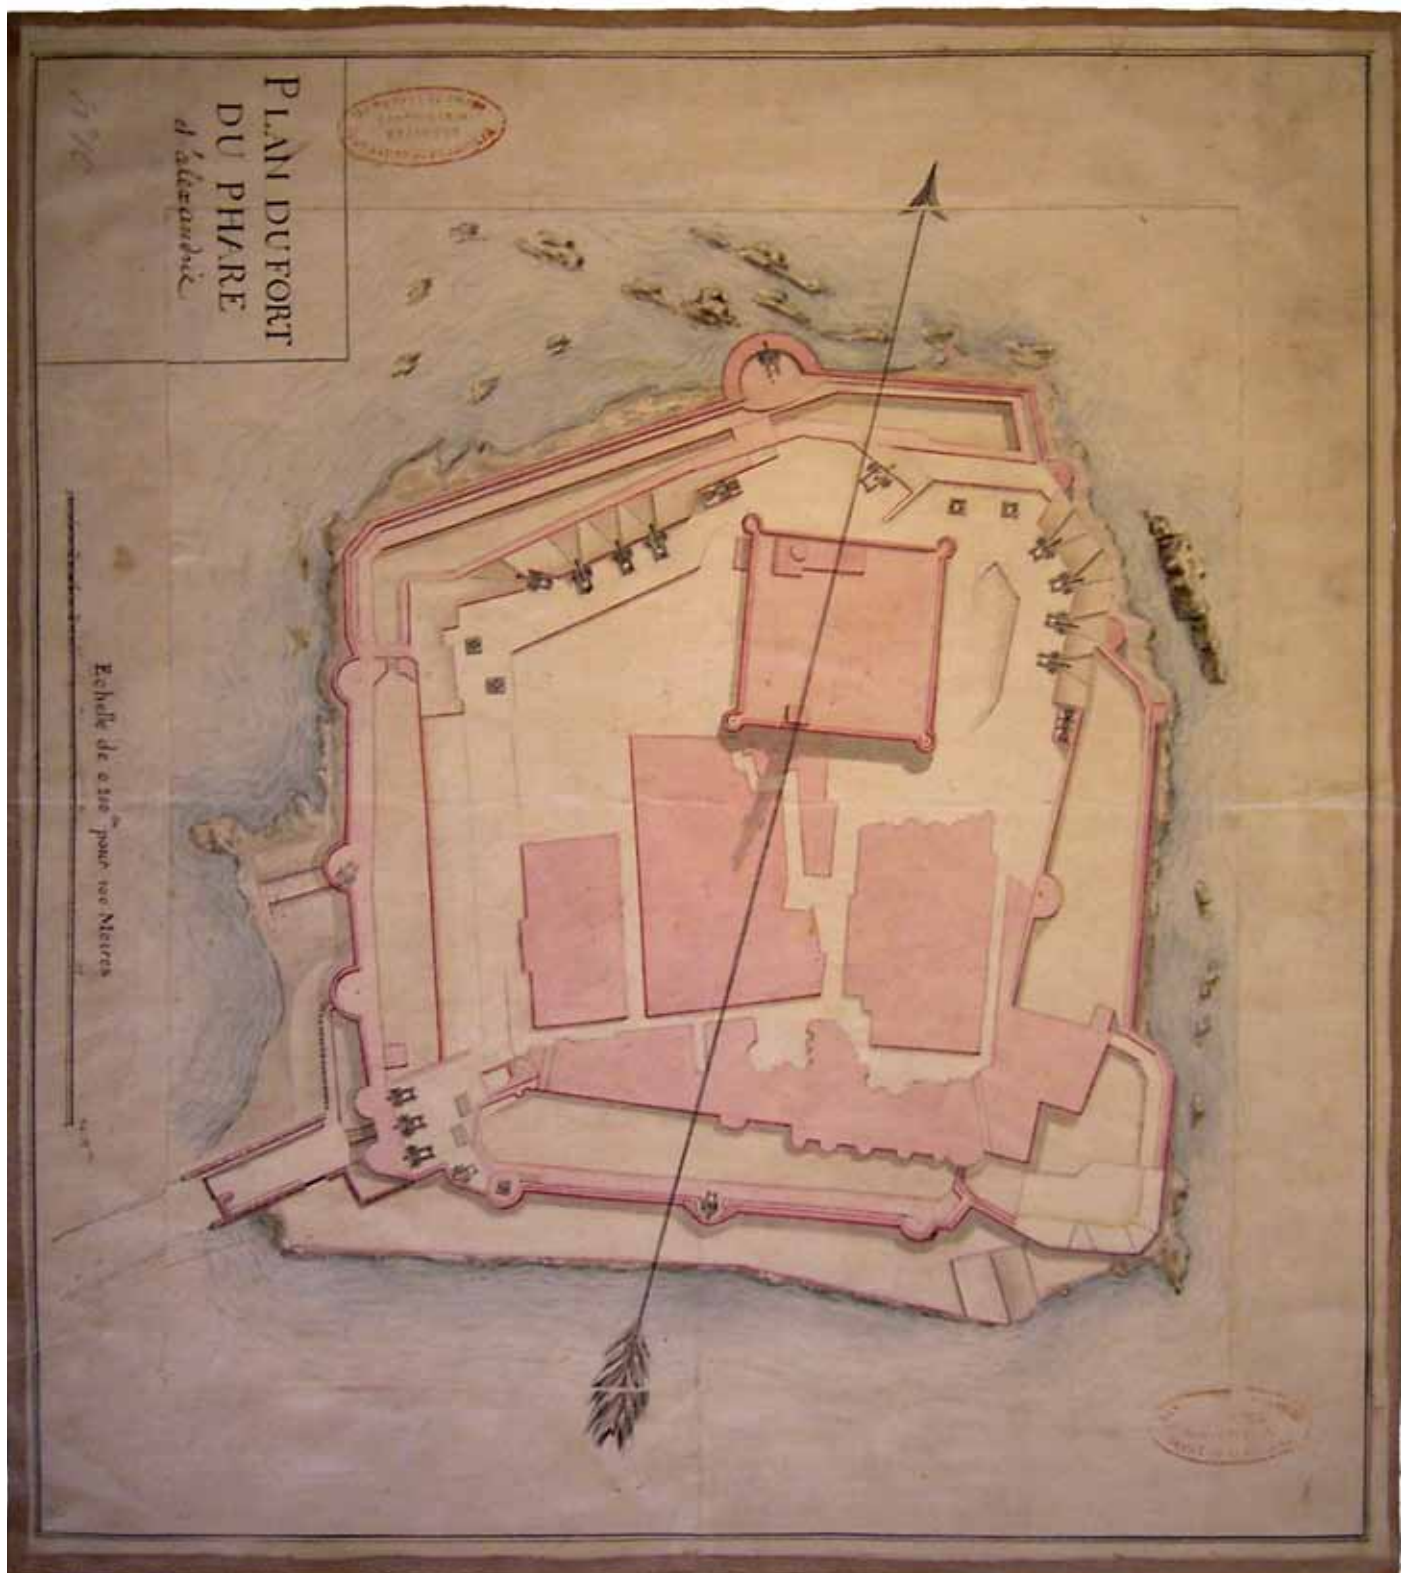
Lageplan: Armée d'Orient, 1798 (SHAT - L II 23, Nr. 10).
